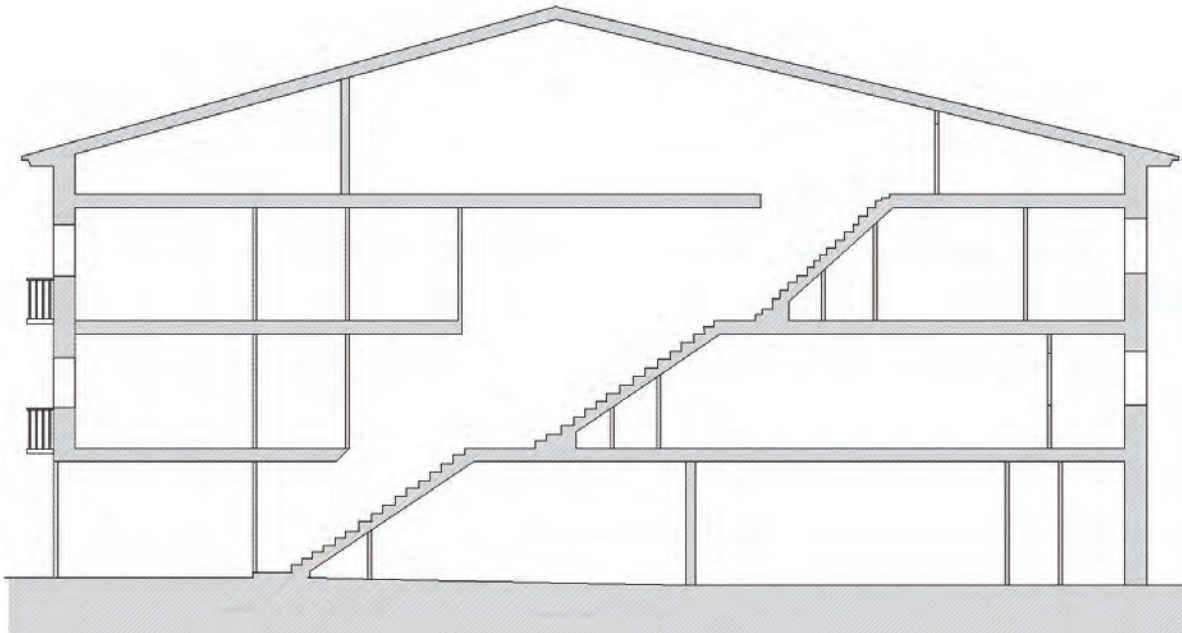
11. SECCIÓN LONGITUDINAL
